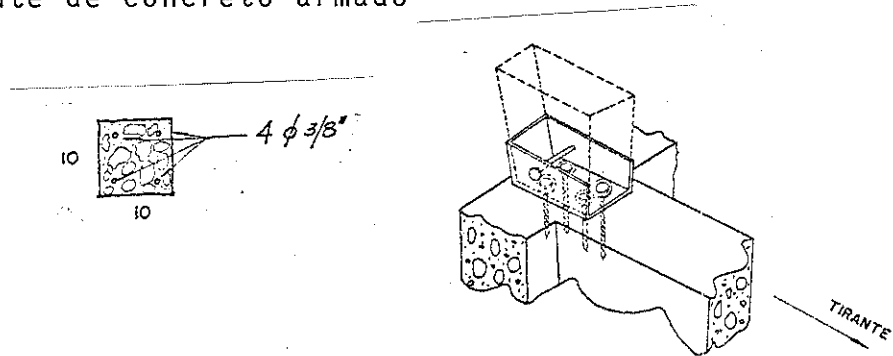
Tirante de Concreto Armado Detalhe
